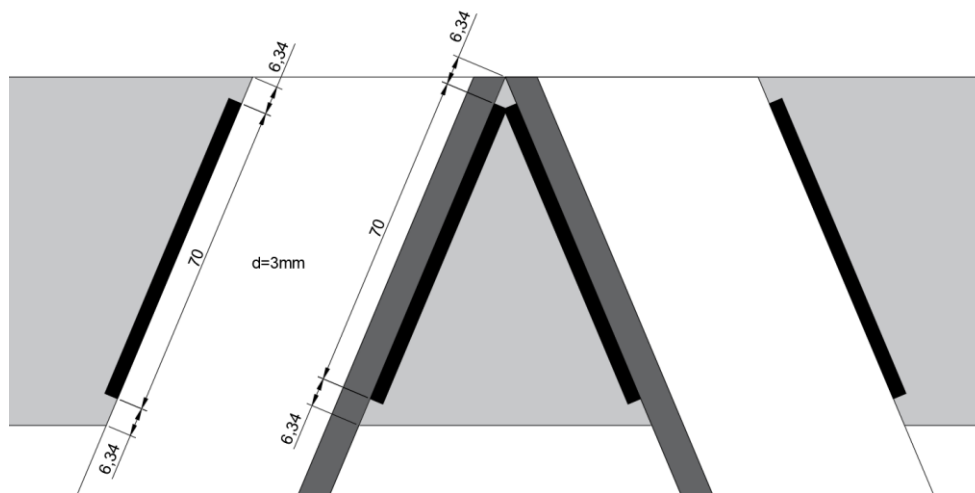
Detalle de unión de barras de celosía de la viga principal Tramo 1
